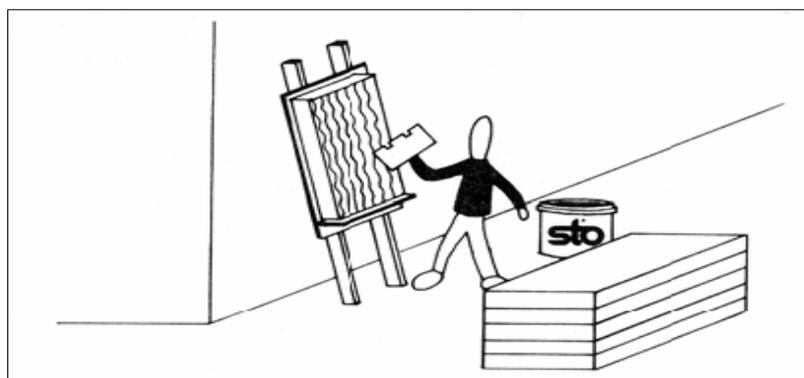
Método de aplicación del adhesivo sobre el aislante.
